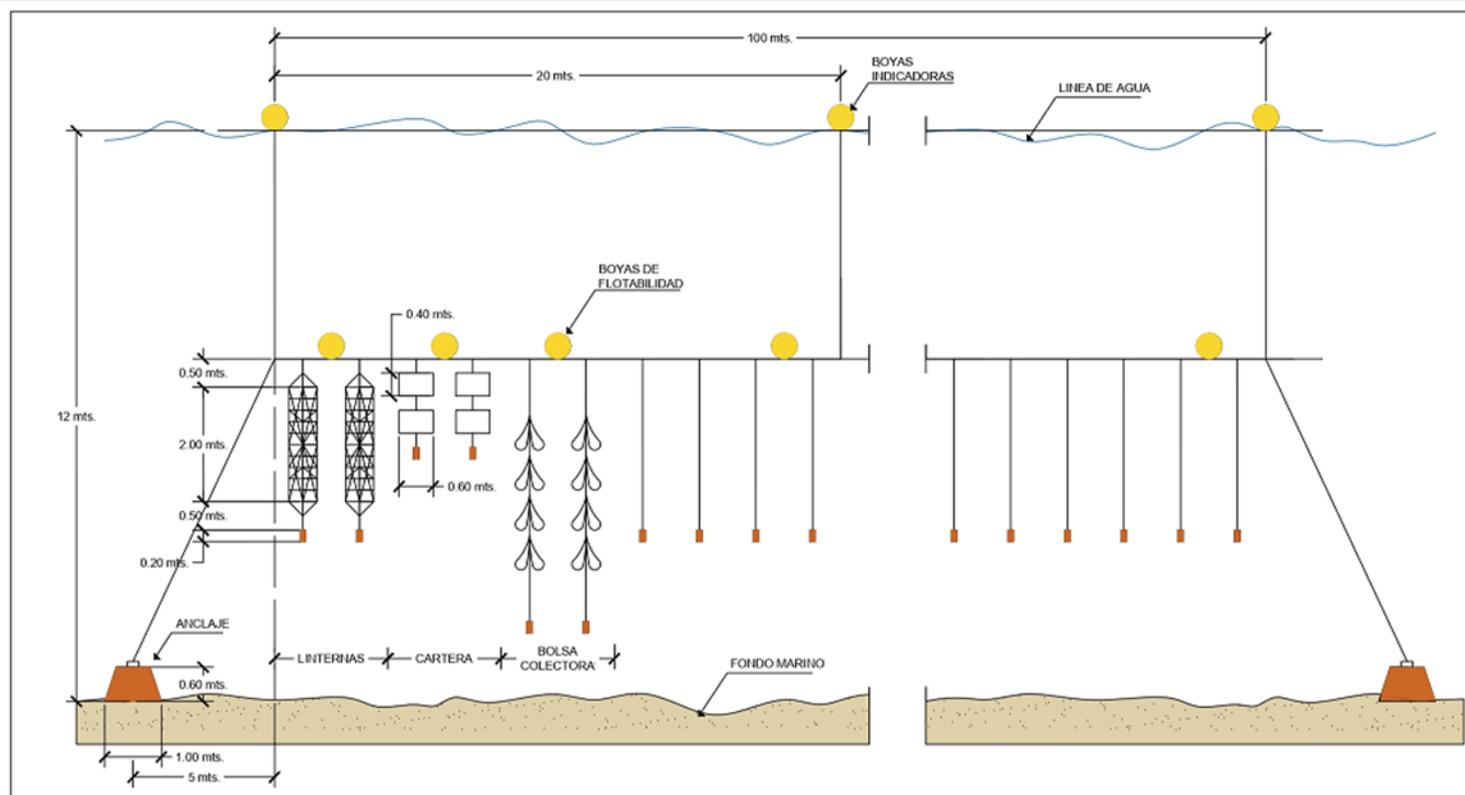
Vista de corte transversal del Sistema constructivo en Long Line
